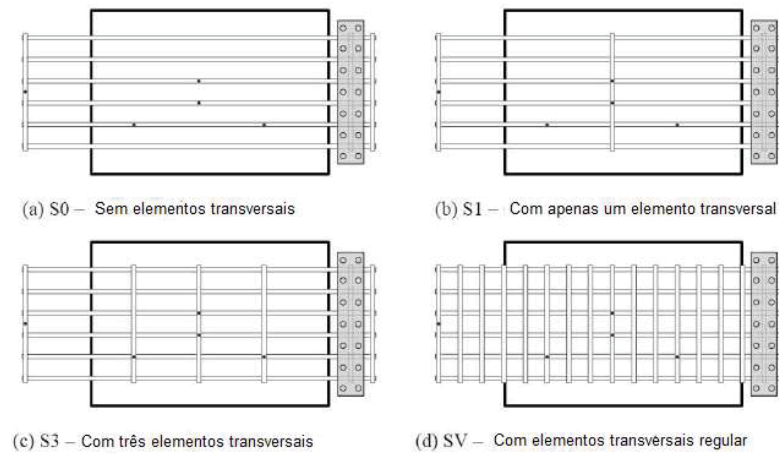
Desenho esquemático do equipamento de pequeno porte utilizado com dimensões de 300 mm x 435 mm
